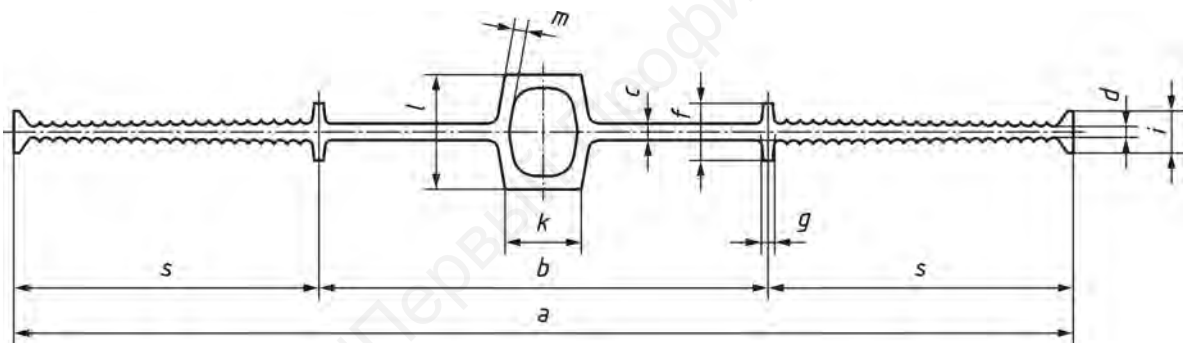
Гидрошпонка тип D, поперечное сечение
